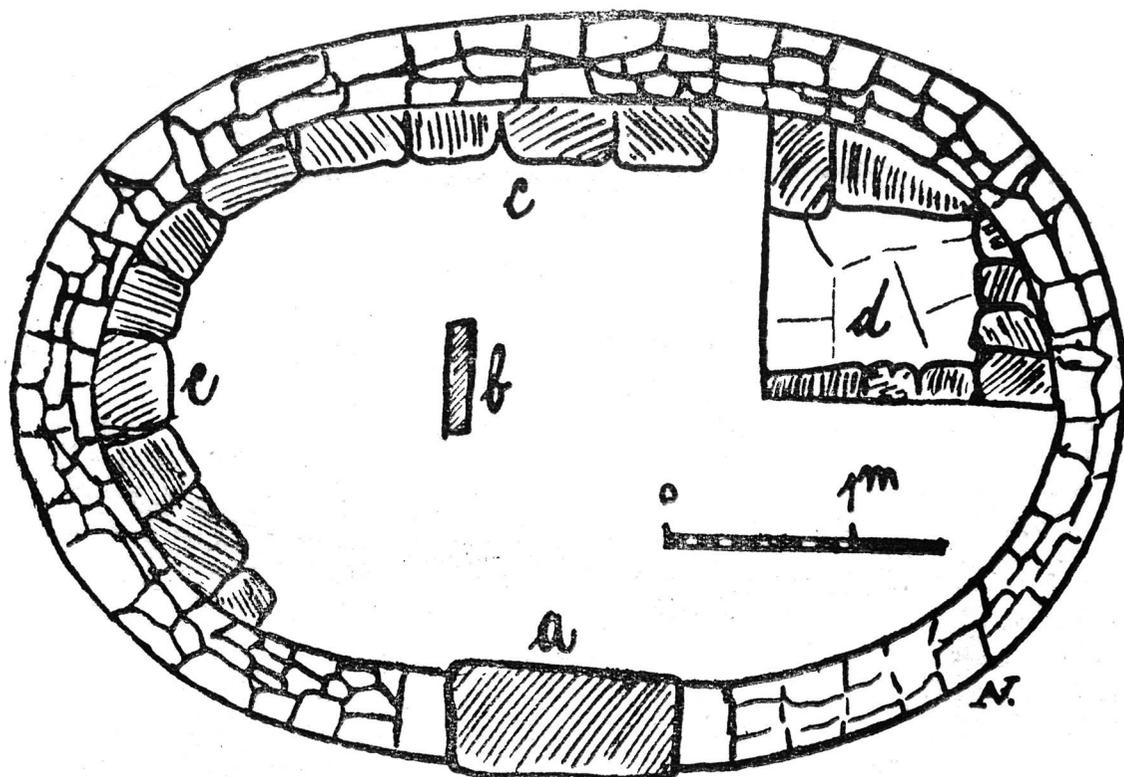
Planta da casa n.º 36: a, soleira; b, pedra vertical, no ponto onde se apoiava o prumo de madeira; c, bancada de lajes; d, forno
